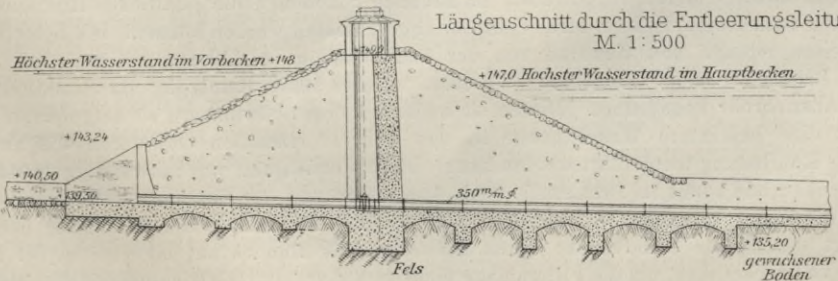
Staudamm mit Betonkern des Solinger Vorbeckens.
